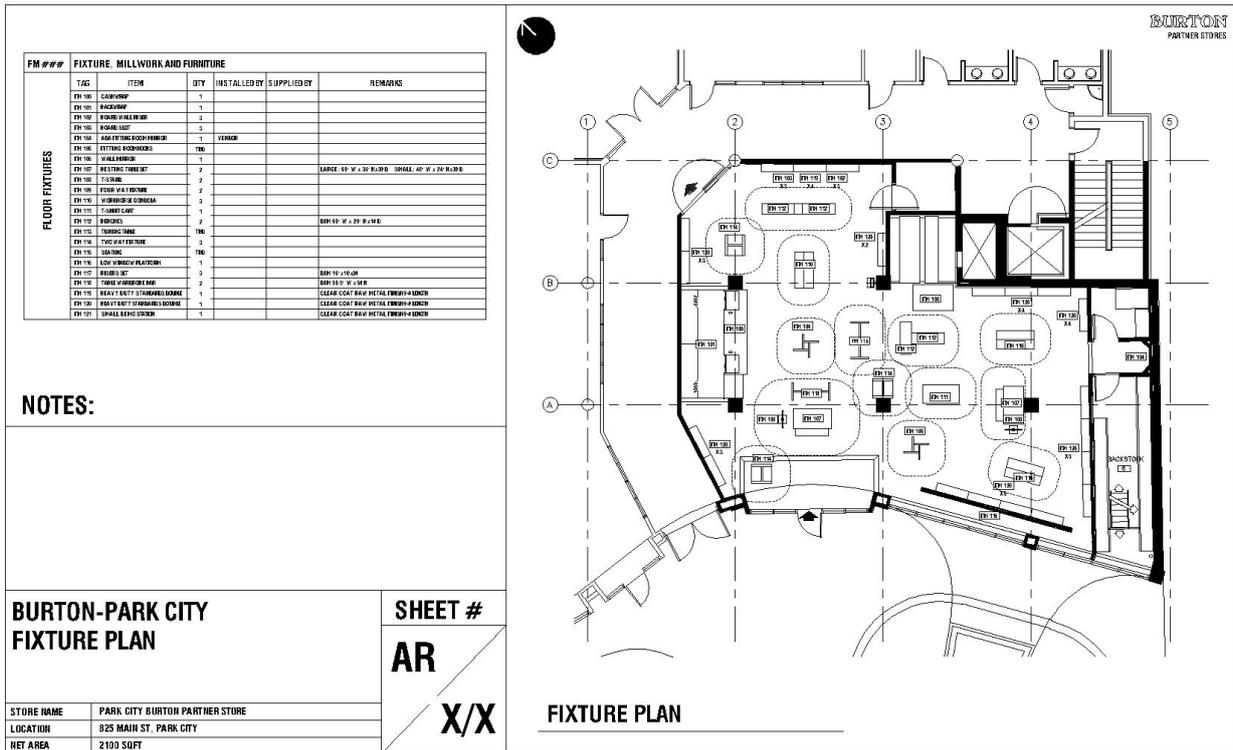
Planta Arquitectónica de la tienda PKC. Fuente: elaboración propia.
